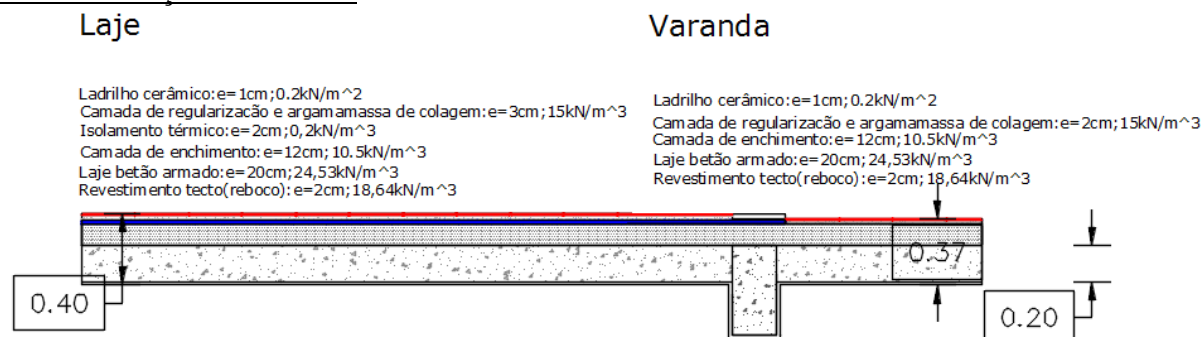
a) Representação esquemática dos pormenores construtivos das lajes e varandas
